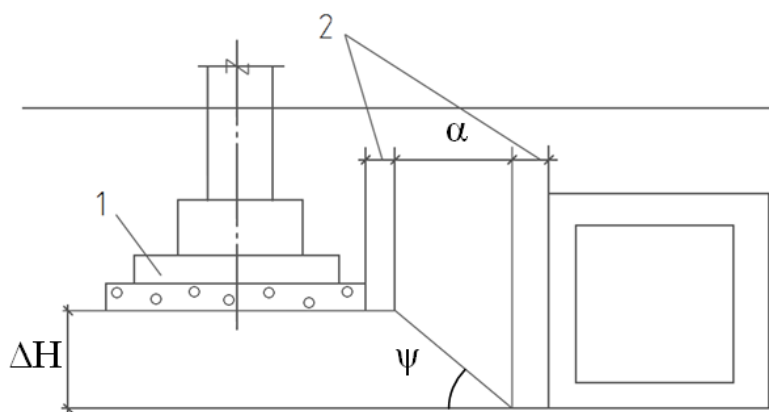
Найменша відстань між підшвами фундаменту будинку або споруди й тунелю або каналу
